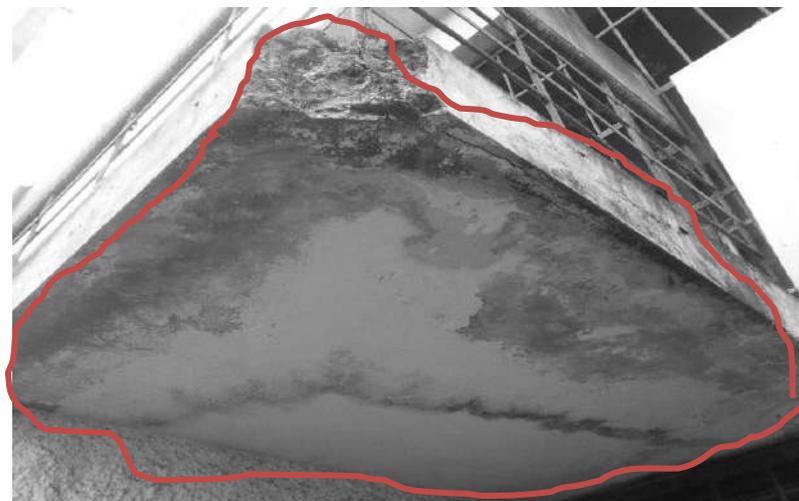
Módulo 02 y 03 - Deterioro de estructura horizontal.
